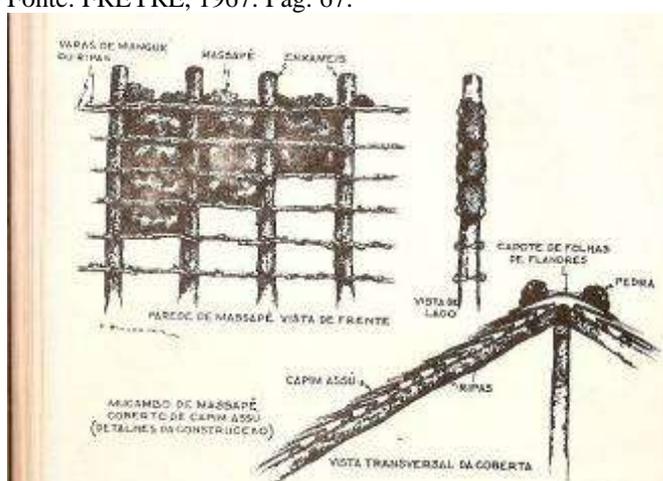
Desenho de M. Bandeira. Detalhes construtivos de casa em massapé
